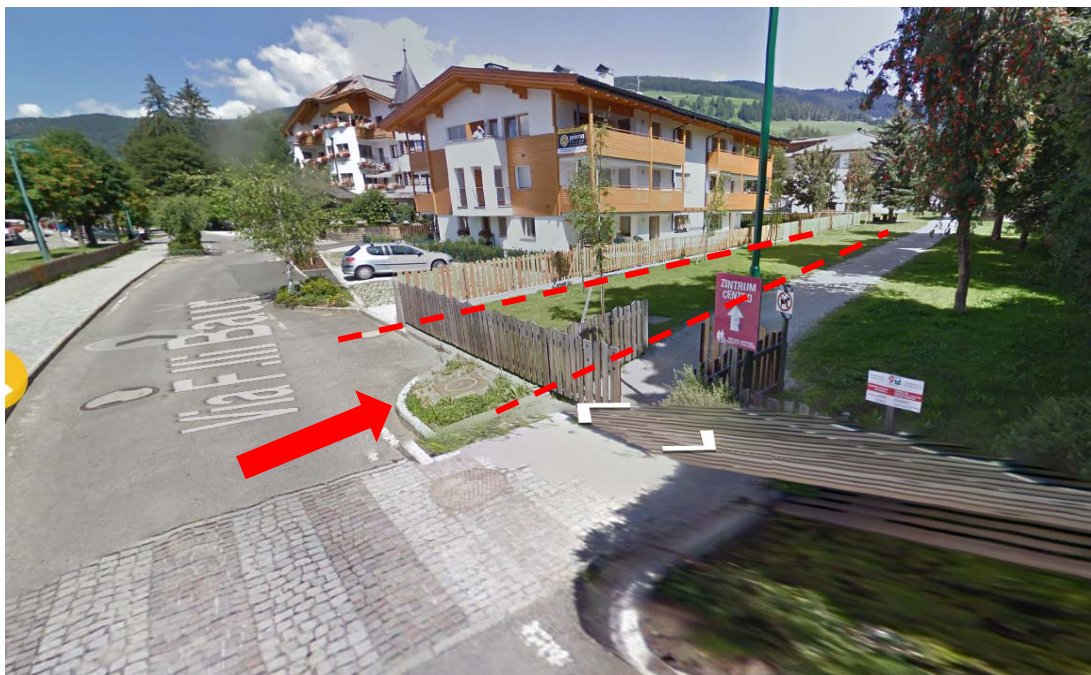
Baustellenzufahrt Süd - Hauptzufahrt
